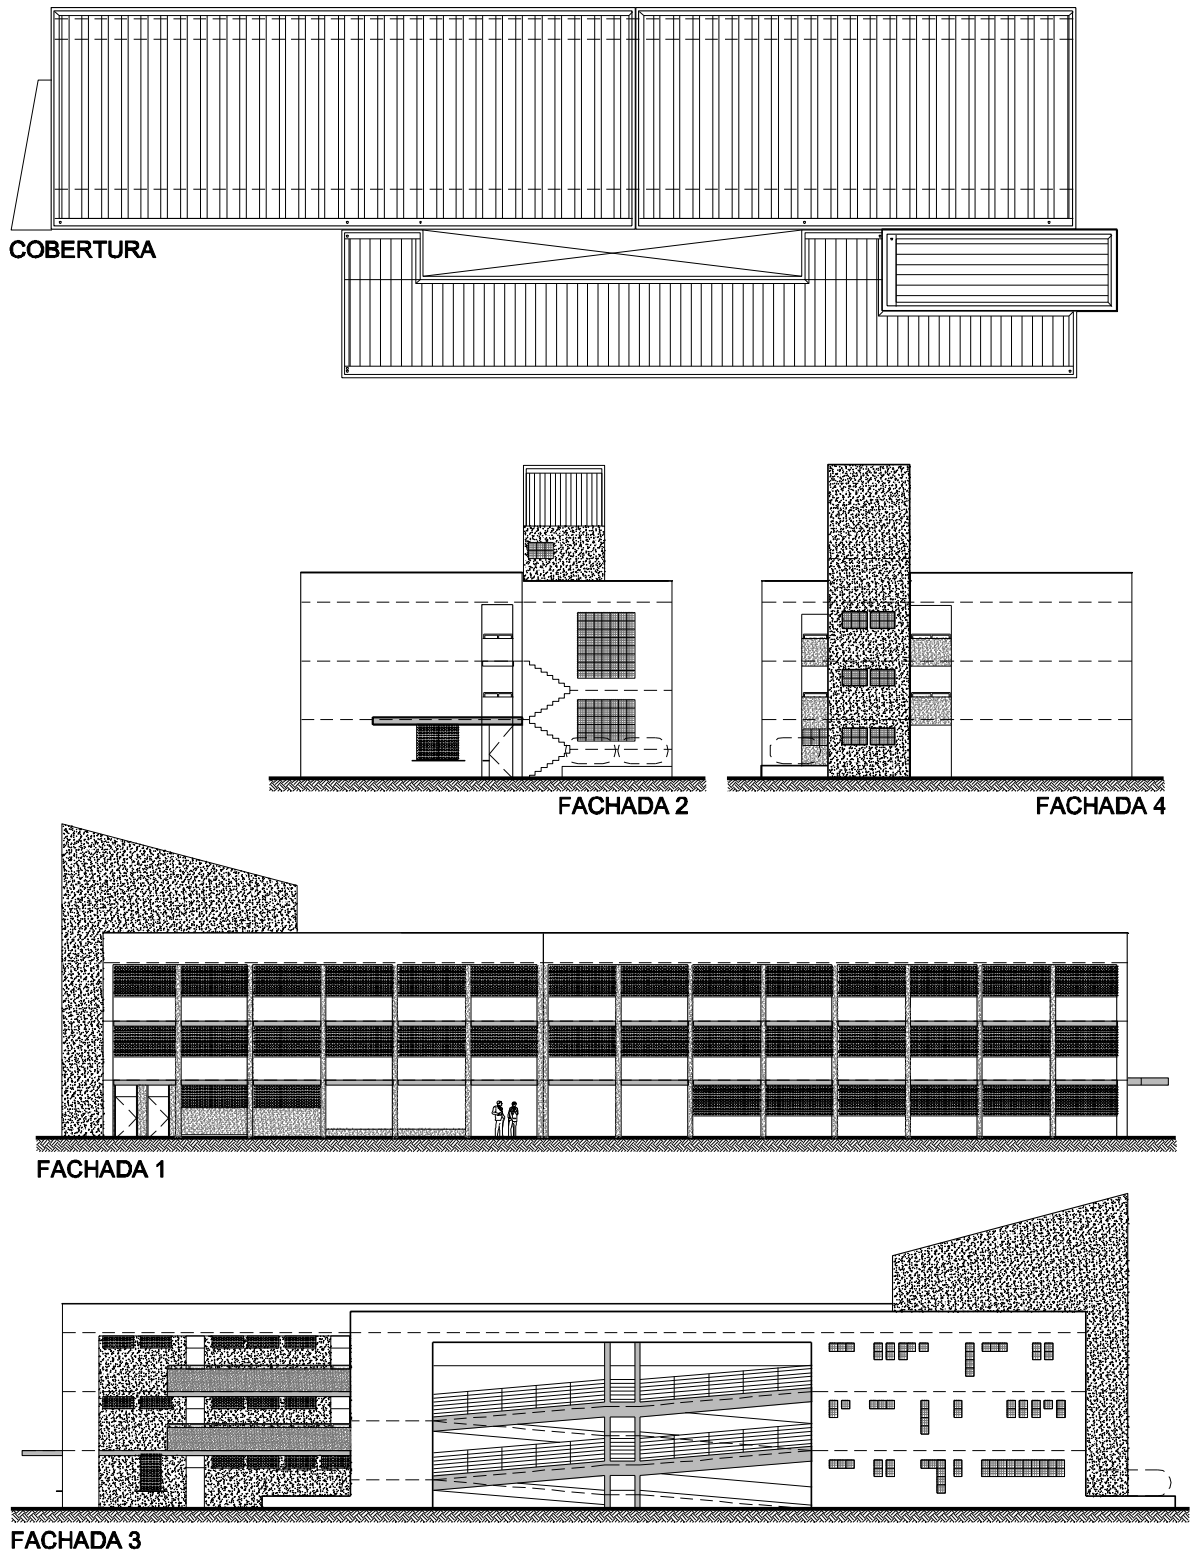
Planta de Cobertura e Fachadas da Escola Padrão PE-3Pav
